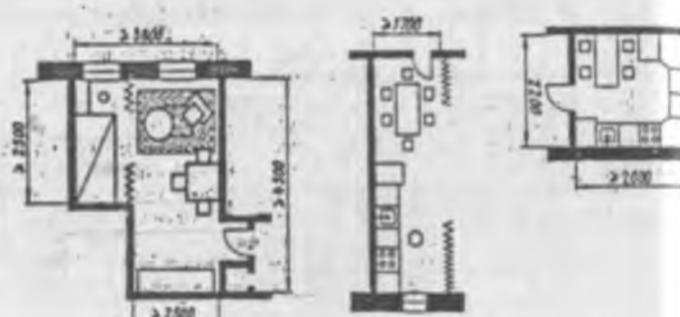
Варианты планировочных решений кухонь при реконструкции жилых зданий
